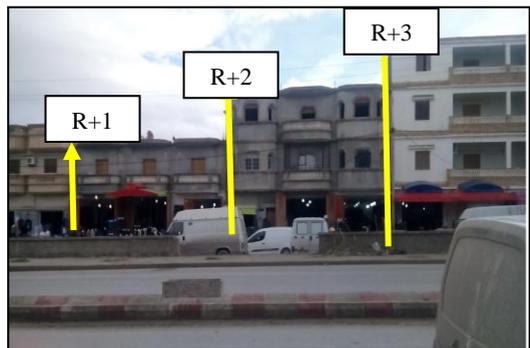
locaux commerciaux aux rez-de-chaussée des villas de 1 à 3 étages implantés sur la route nationale N°10
